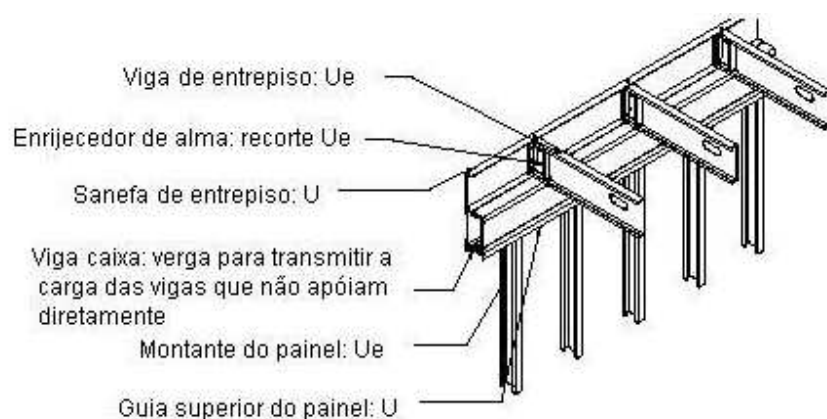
Viga em perfil caixa para apoio das vigas não alinhadas com os montantes
